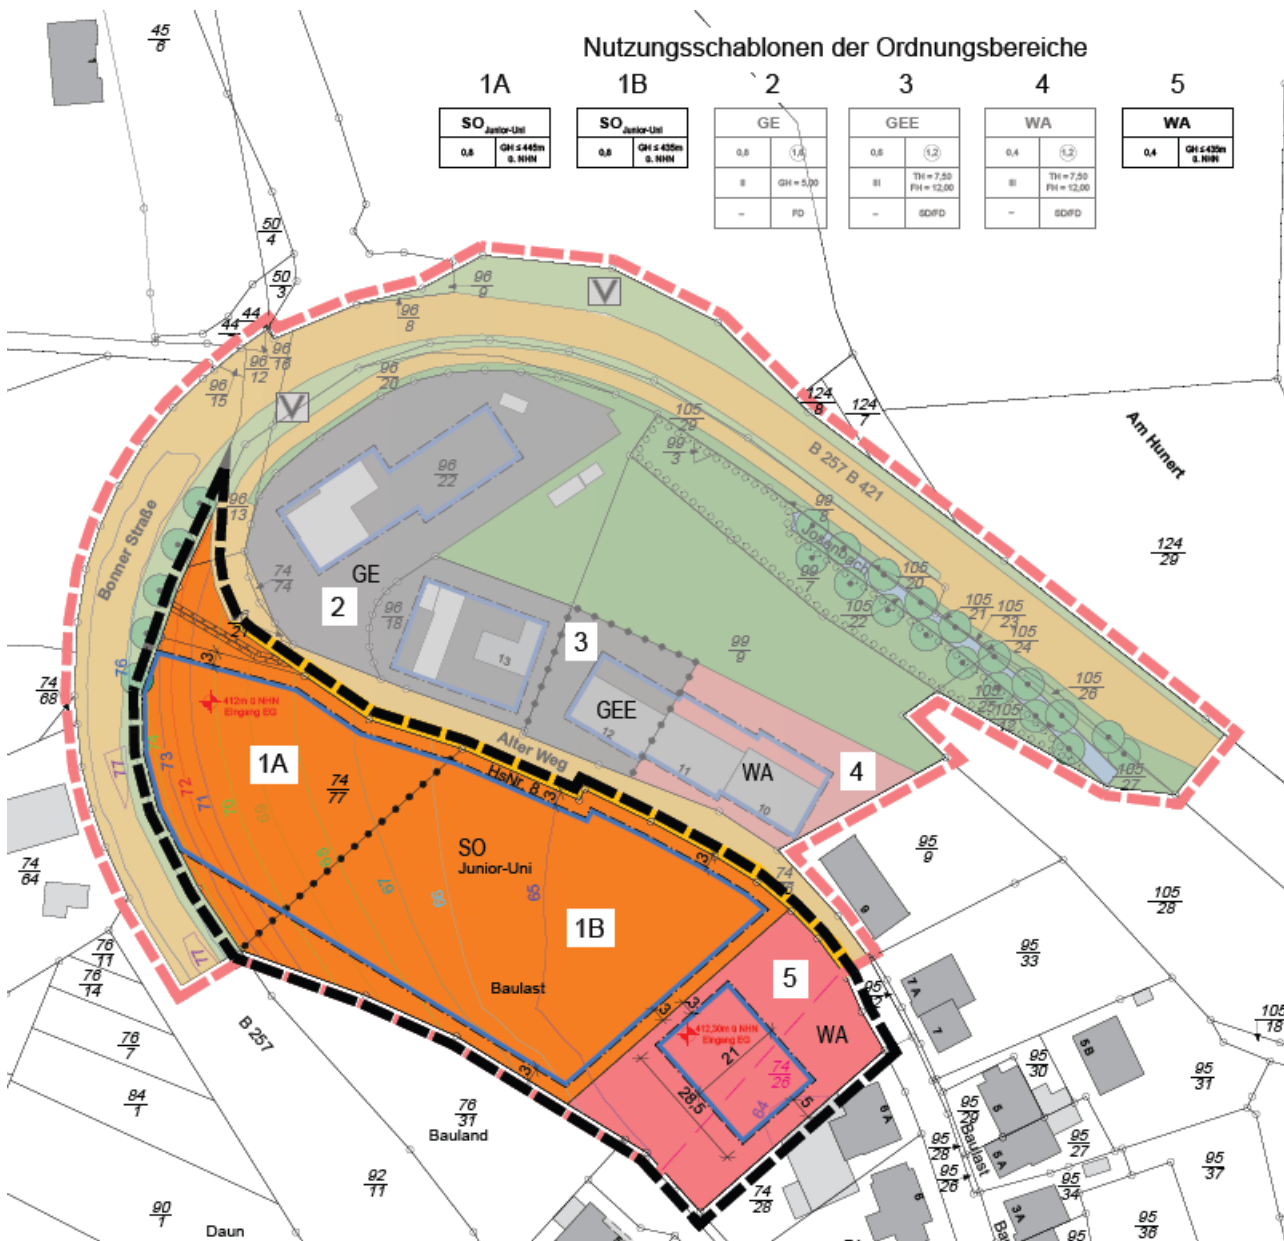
Auszug aus der geplanten Plandarstellung des Bebauungsplanes 2. Änderung „Alter Weg“ (Quelle: ISU Bitburg, Stand: 05. Mai 2022)
